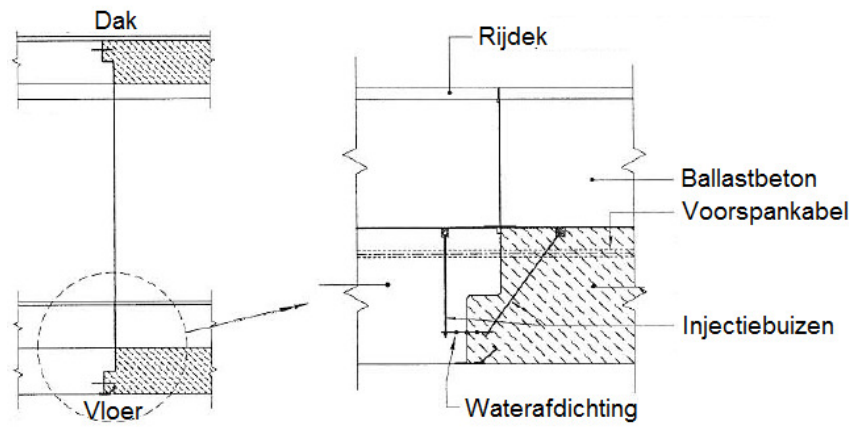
Segmentvoegen. Boven: tunnelsegment met tandverdeueling in de wanden. Onder: tunnelsegment met kraagconstructie rondom de doorsnede.
